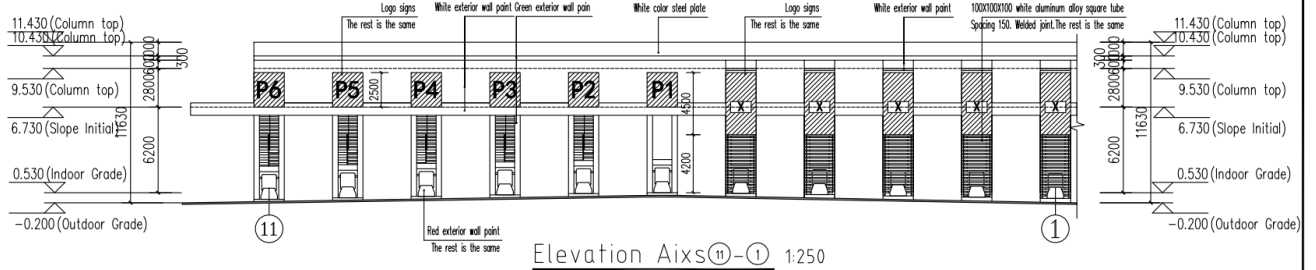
Alçado frontal do edifício. (fonte: projecto estrutural da portagem de Zintava da CRBC)
